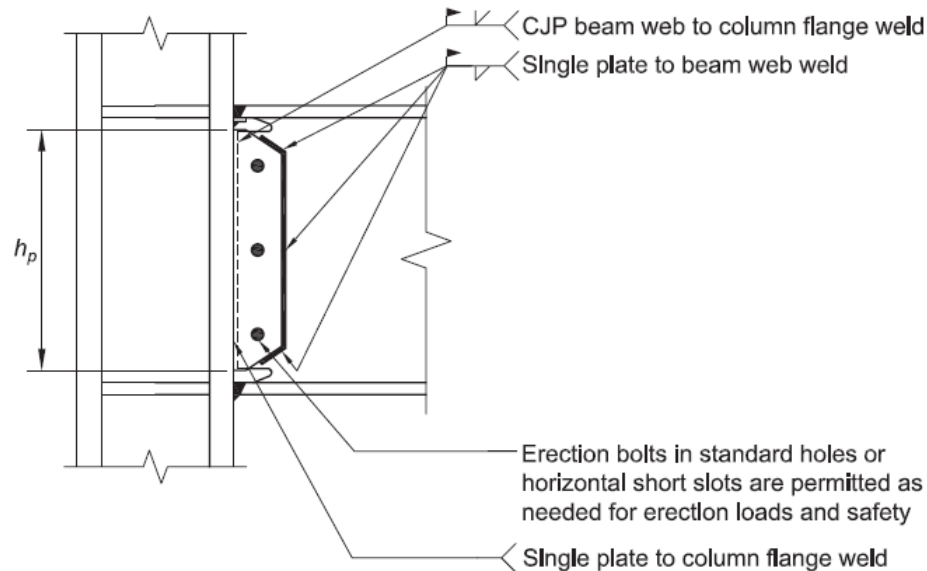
Detalles generales conexión alma viga a ala columna.
